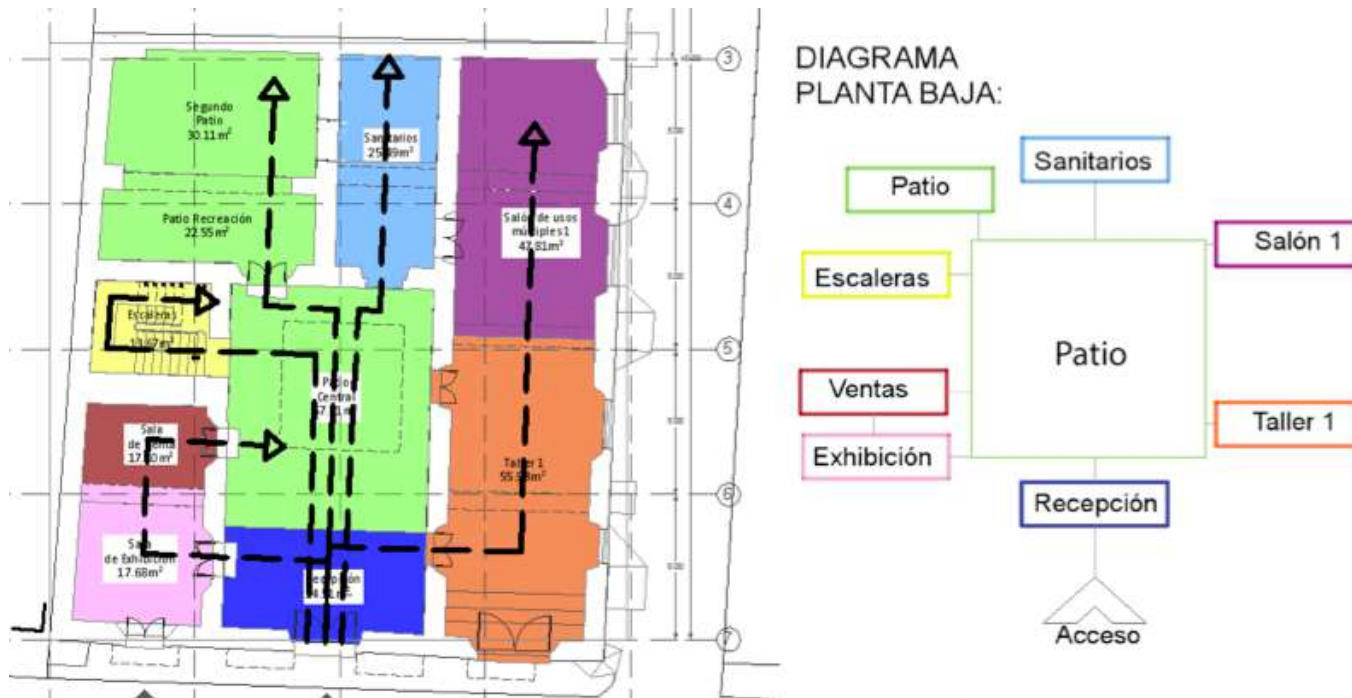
Zonificación y diagramas de funcionamiento Planta Baja. Fuente: elaboración propia.
